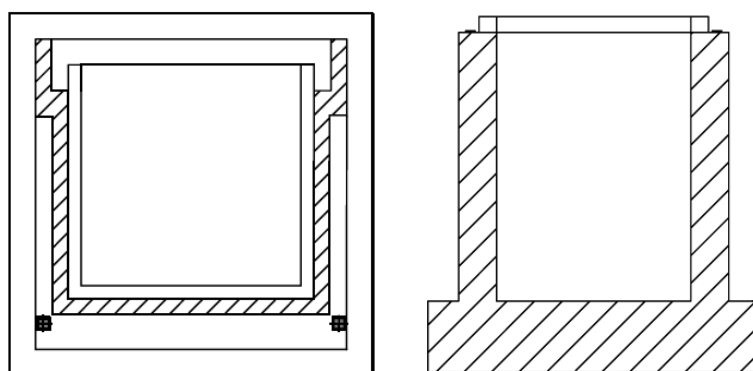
b. Planta y sección estribo cerrado en cajón
